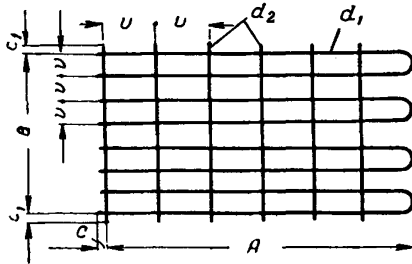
Сварная сетка с изогнутой рабочей арматурой
